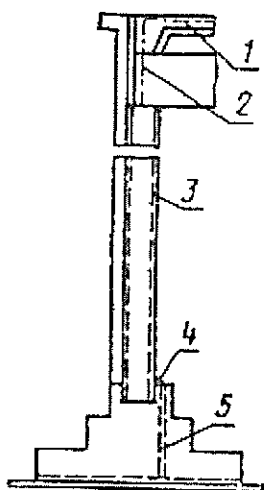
Соединение арматуры железобетонных конструкций:
